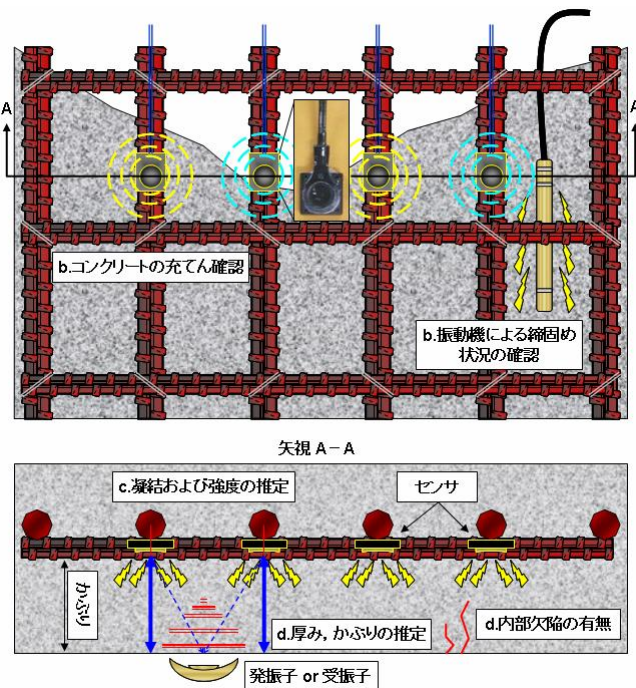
振動解析技術を用いたコンクリート構造物の品質管理
